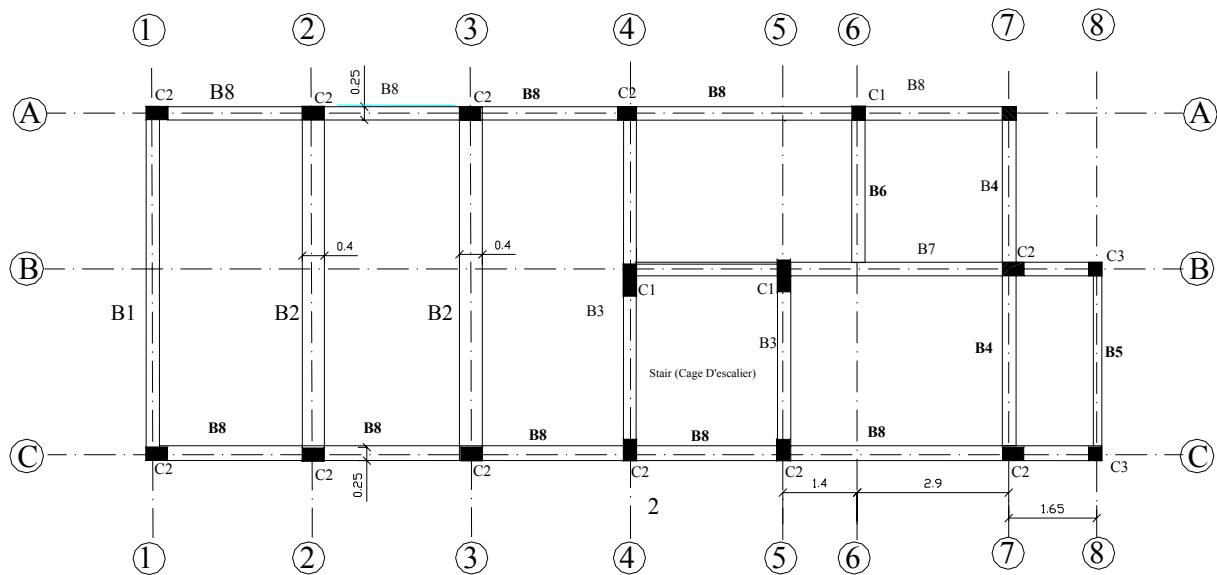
رسم إنشائي يبين مسقط رأسي للأعمدة
